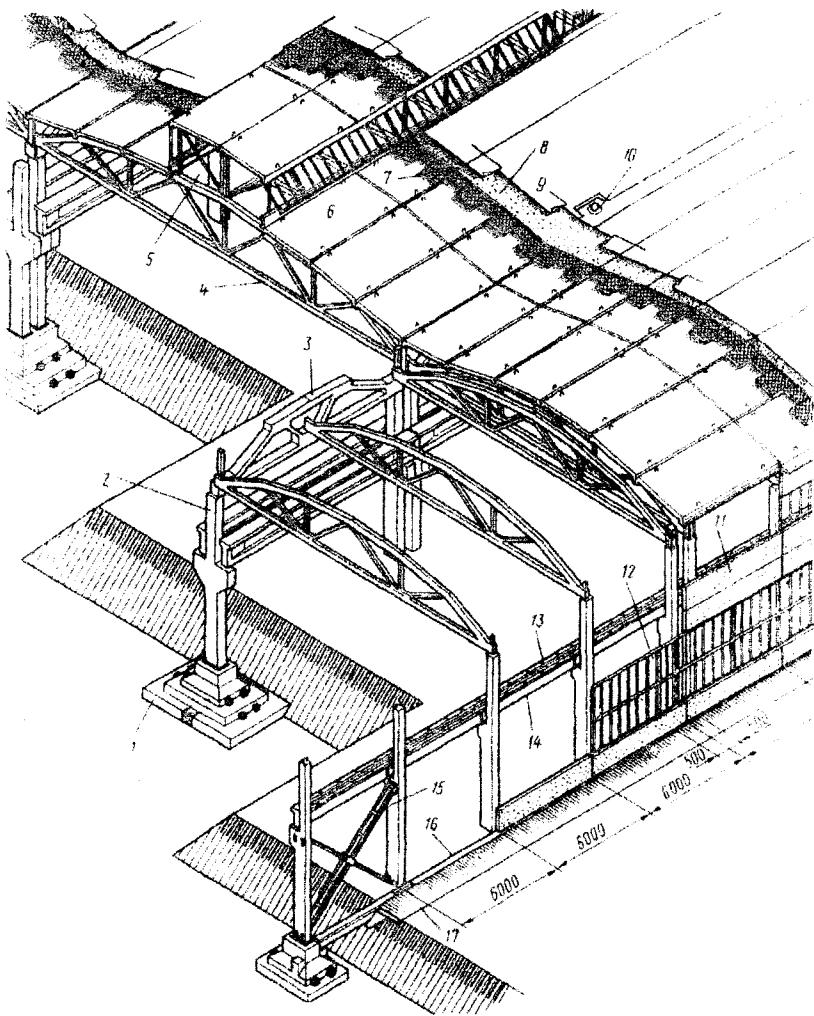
Залізобетонний каркас одноповерхової будівлі:
